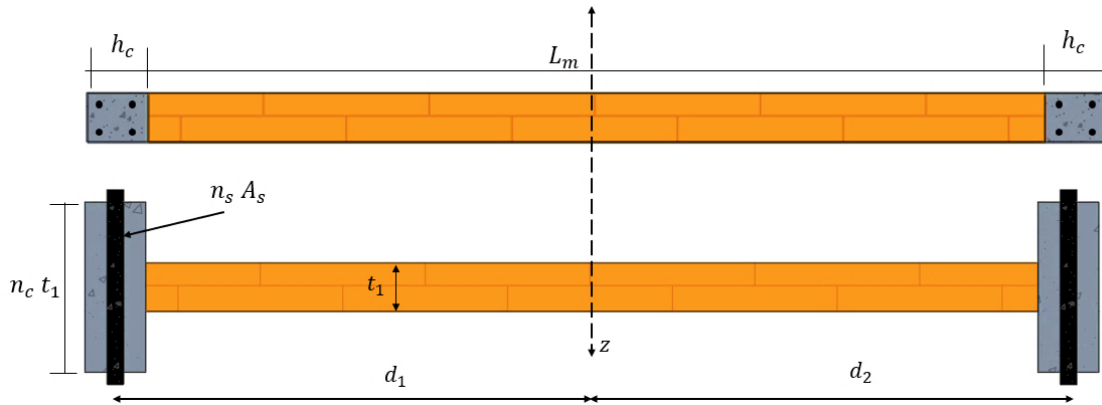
Sección transformada de un muro de mampostería confinada incluyendo al acero de refuerzo como tercer material
